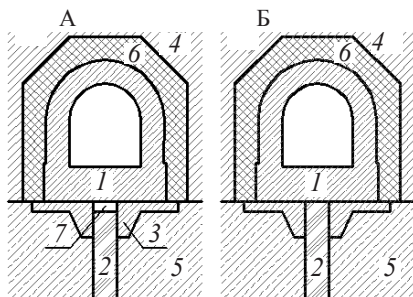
Схемы А и Б сопряжения стены с потерней: 1 – потерня; 2 – «стена в грунте»; 3 – форшахта; 4 – грунт ядра плотины; 5 – грунт основания; 6 – бенитовая «рубашка»; 7 – полость
